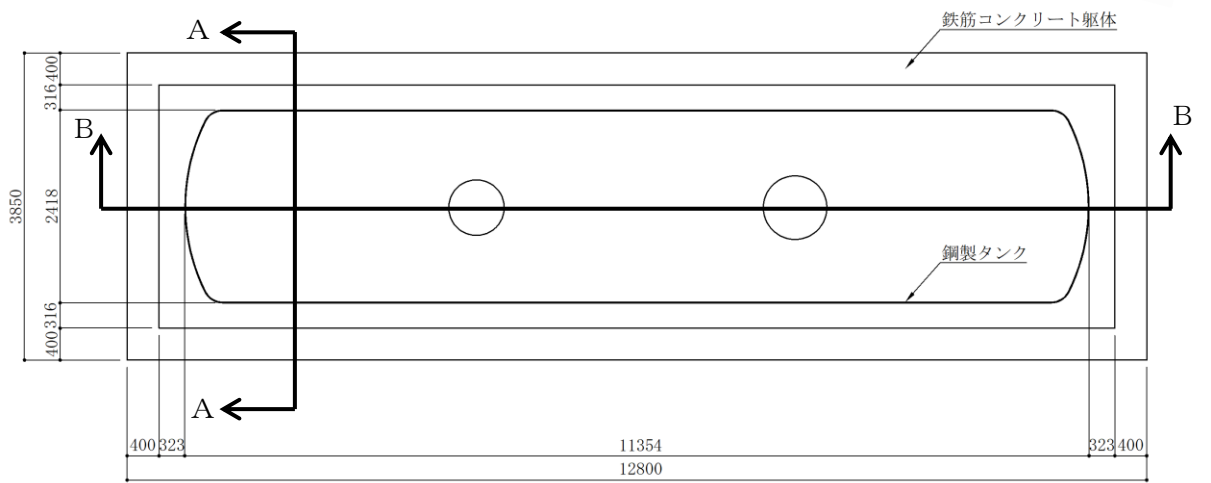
緊急時対策所用燃料地下タンク 平面図 (単位: mm)
